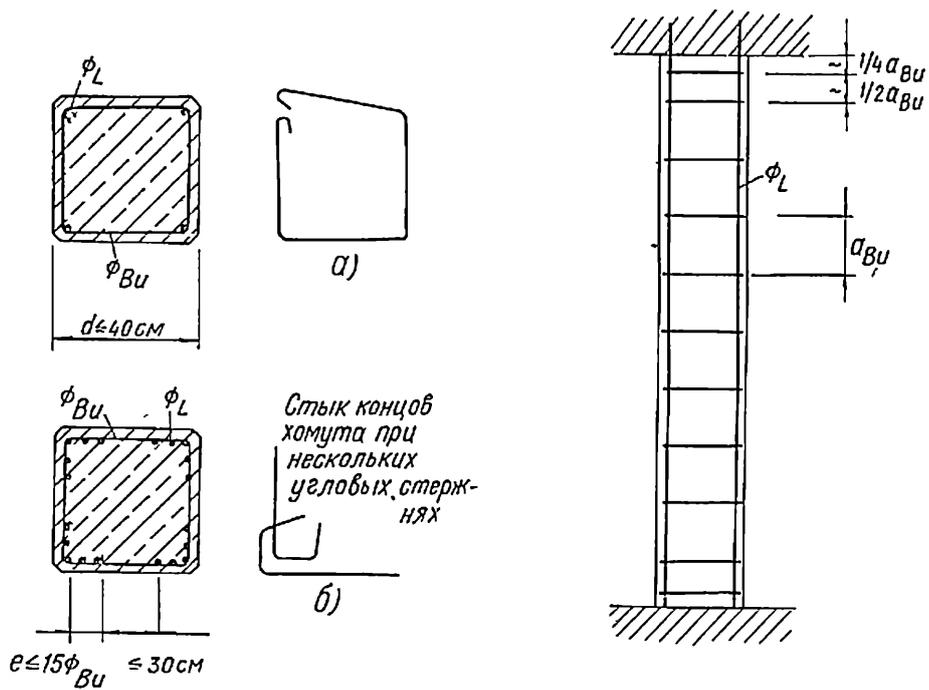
2. Вверху и внизу колонн первые два-три хомута распределяются с шагом $1/2 - 1/4 a_{Bu}$
